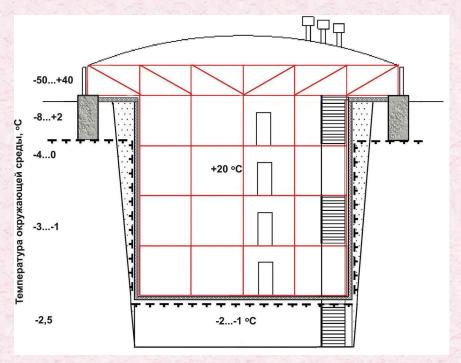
Проект подземного дома в условиях распространения многолетнемерзлых пород. Здание подвешено на ферме, опирающейся на фундамент, заглубленный в мерзлое основание
